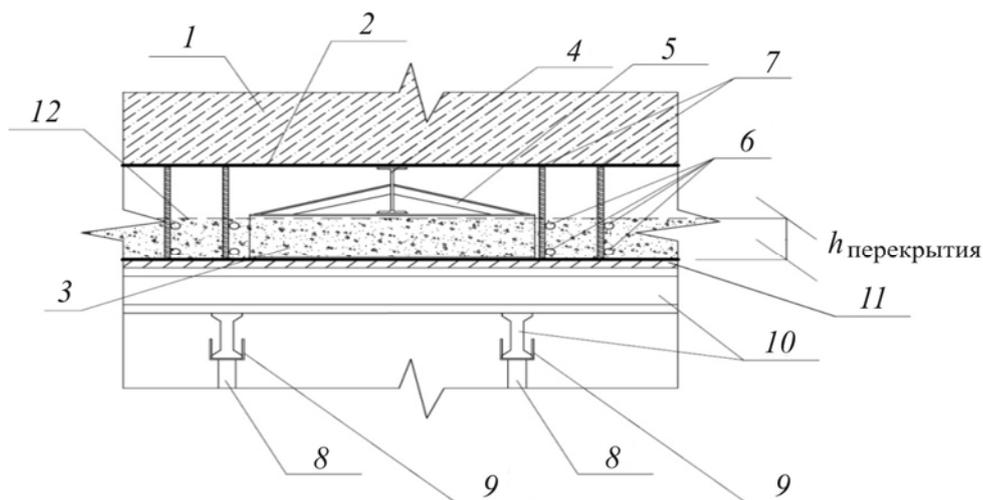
Вид 1—1: 1 — монолитная стена; 2 — оставленная при бетонировании ниша; 3 — двутавровая балка, подобранная по условию $h \geq h_n$, где h — высота двутавра, h_n — высота перекрытия; 4 — поперечная двутавровая балка на ширину пролета; 5 — раскос для устойчивости поперечной двутавровой балки; 6 — выпуски арматуры в монолитной стене, предусмотренные по предварительному расчету; 7 — продольные вертикальные арматурные стержни монолитной стены; 8 — телескопическая поддерживающая стойка; 9 — вилка телескопической стойки; 10 — деревянная балка (ригель); 11 — щиты опалубки (ламинированная фанера); 12 — поверхность монолитной плиты
